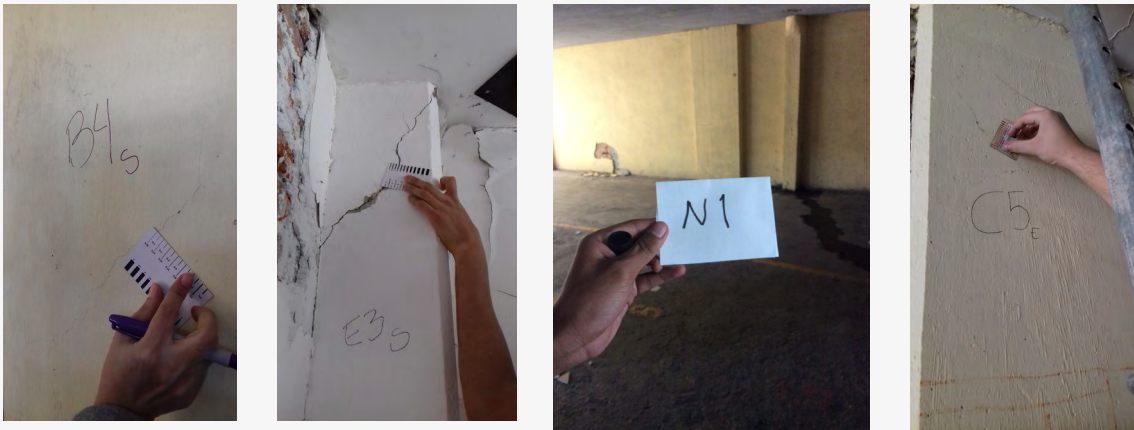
Ejemplos de identificación de caras de elementos estructurales (columnas) y de medición del ancho de grietas usando comparadores manuales.
